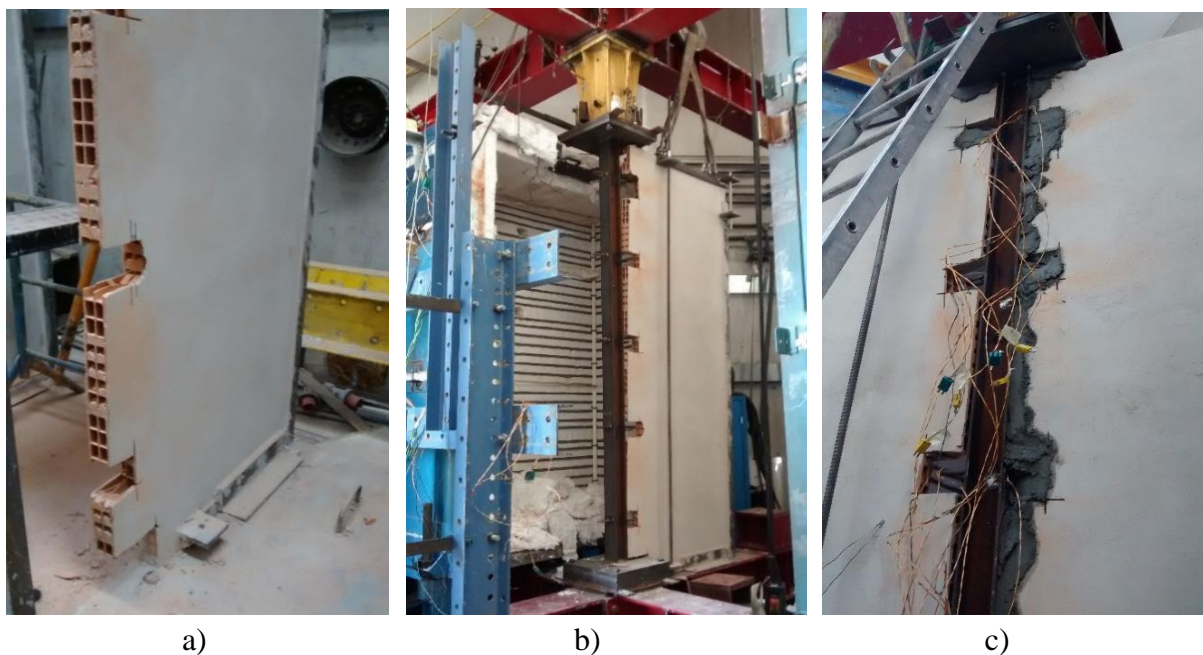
Pormenores de ligação entre as paredes, o pilar com a alma paralela às mesmas e o pórtico a) rasgos para posterior ancoragem da parede à coluna de teste b) ligação pilar – parede c) ancoragem da ligação pilar – parede
